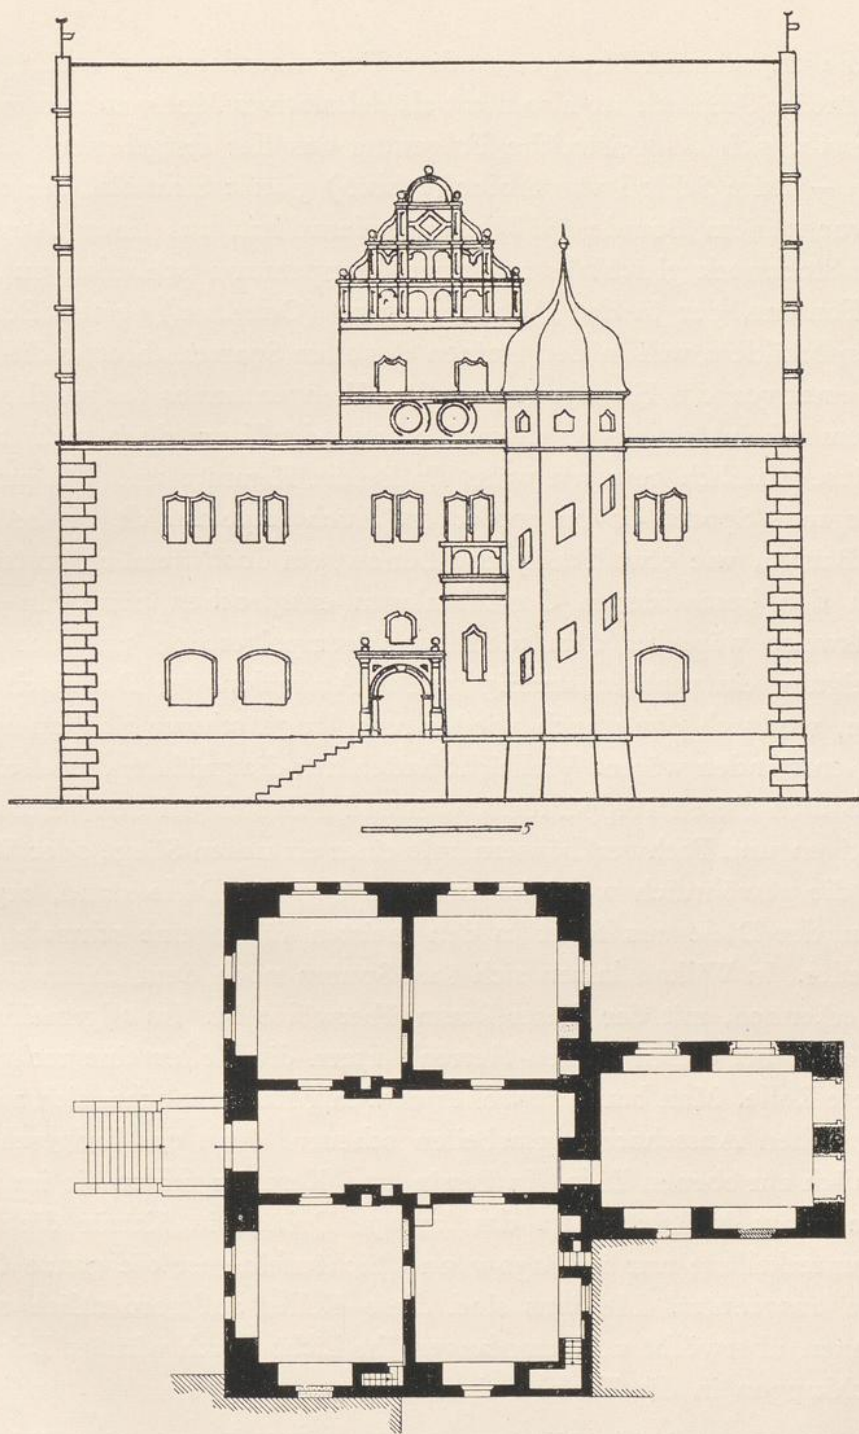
Stolpe. Grundriß und Rekonstruktionsversuch von Eichholz
